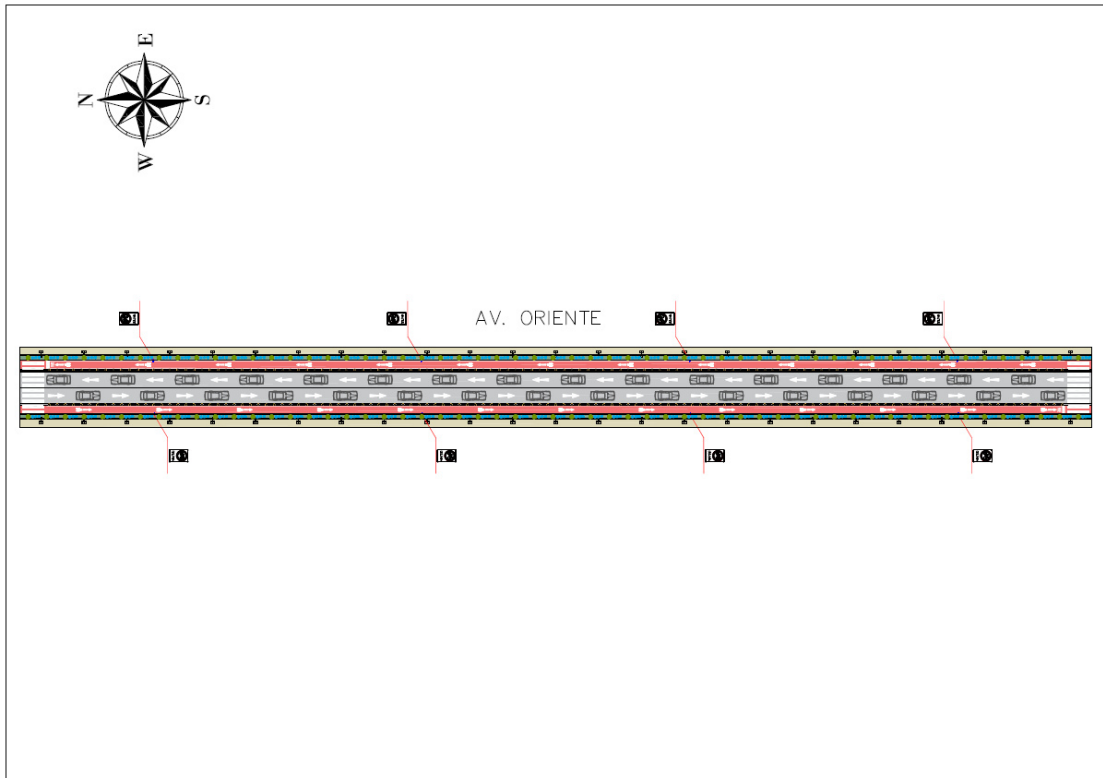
Vista de planta Av. Oriente*Figura 75*Vista 3D Av. Oriente
